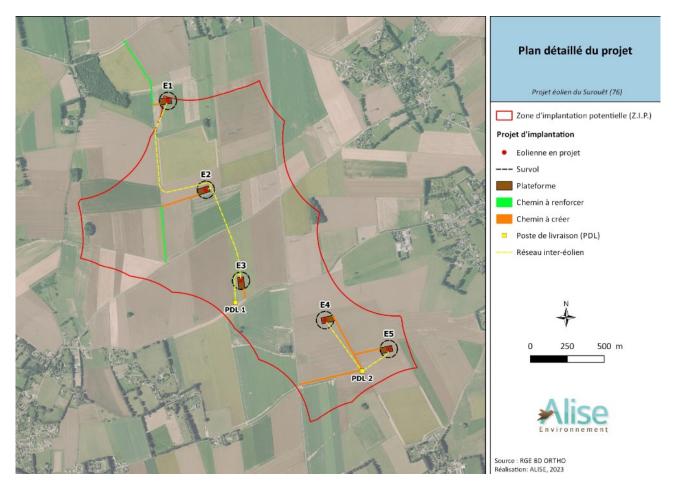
Plan d'implantation des éoliennes (source : p. 24 de l'El)
